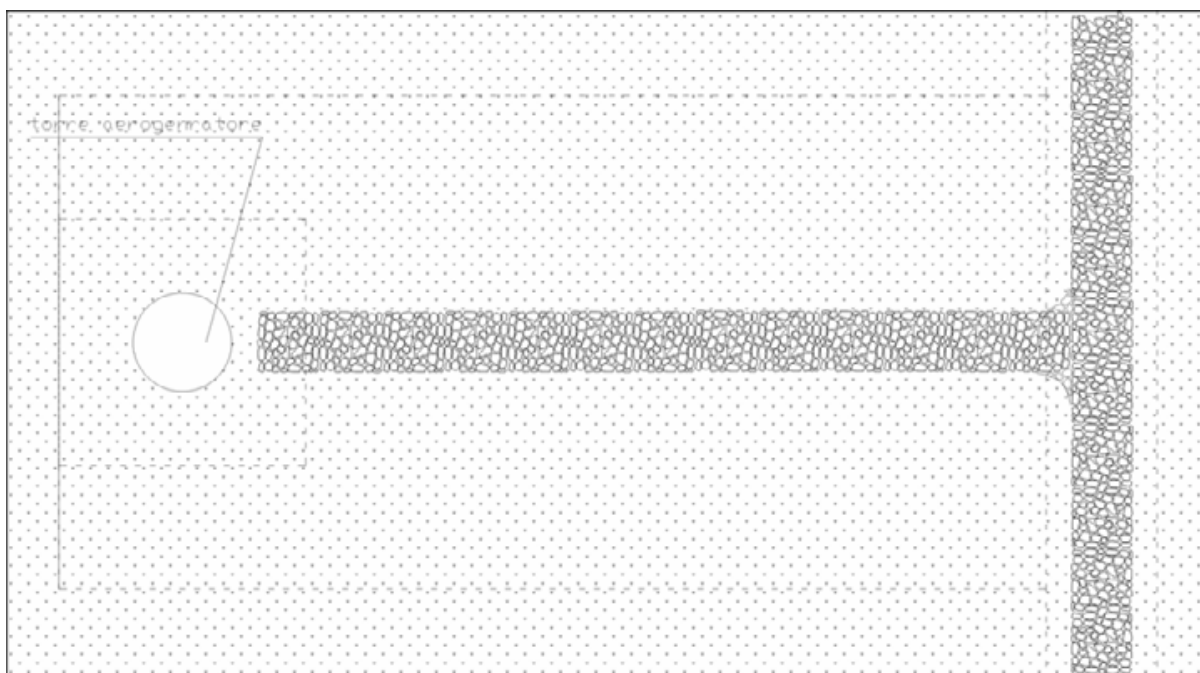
"Pavimentazione verde" nelle piazzole di montaggio
